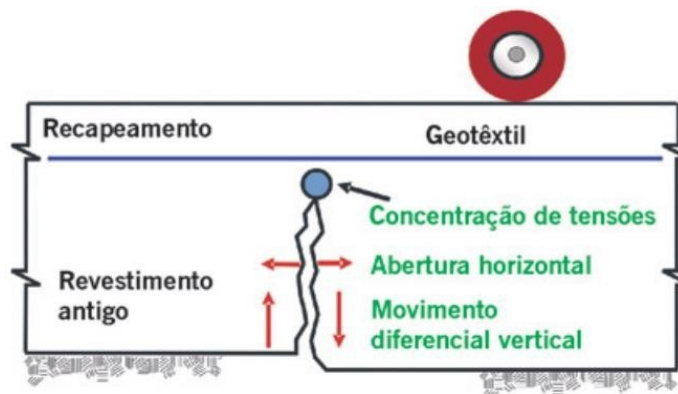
Posicionamento de geotêxtil em pavimento recapeado.
